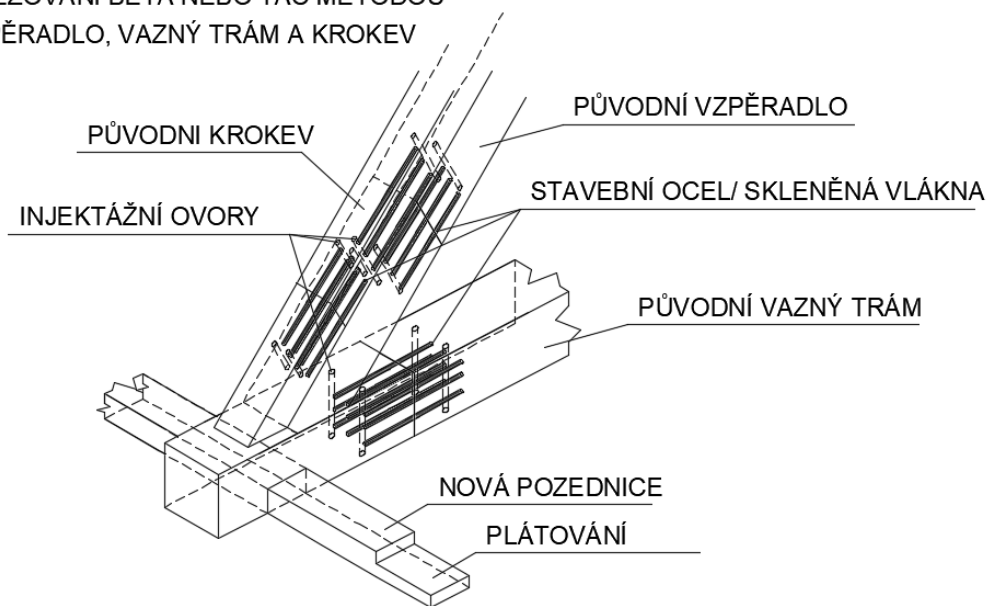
Protézování nepravý čep u lokálně poškozených krokve
